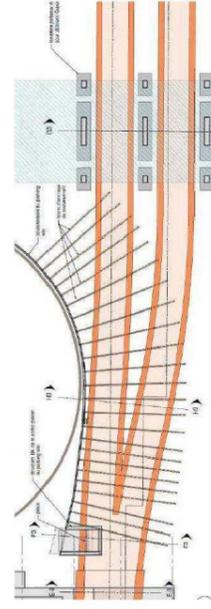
Vue en plan - Solution bicadre à proximité du parking silo et sous l'immeuble pont
